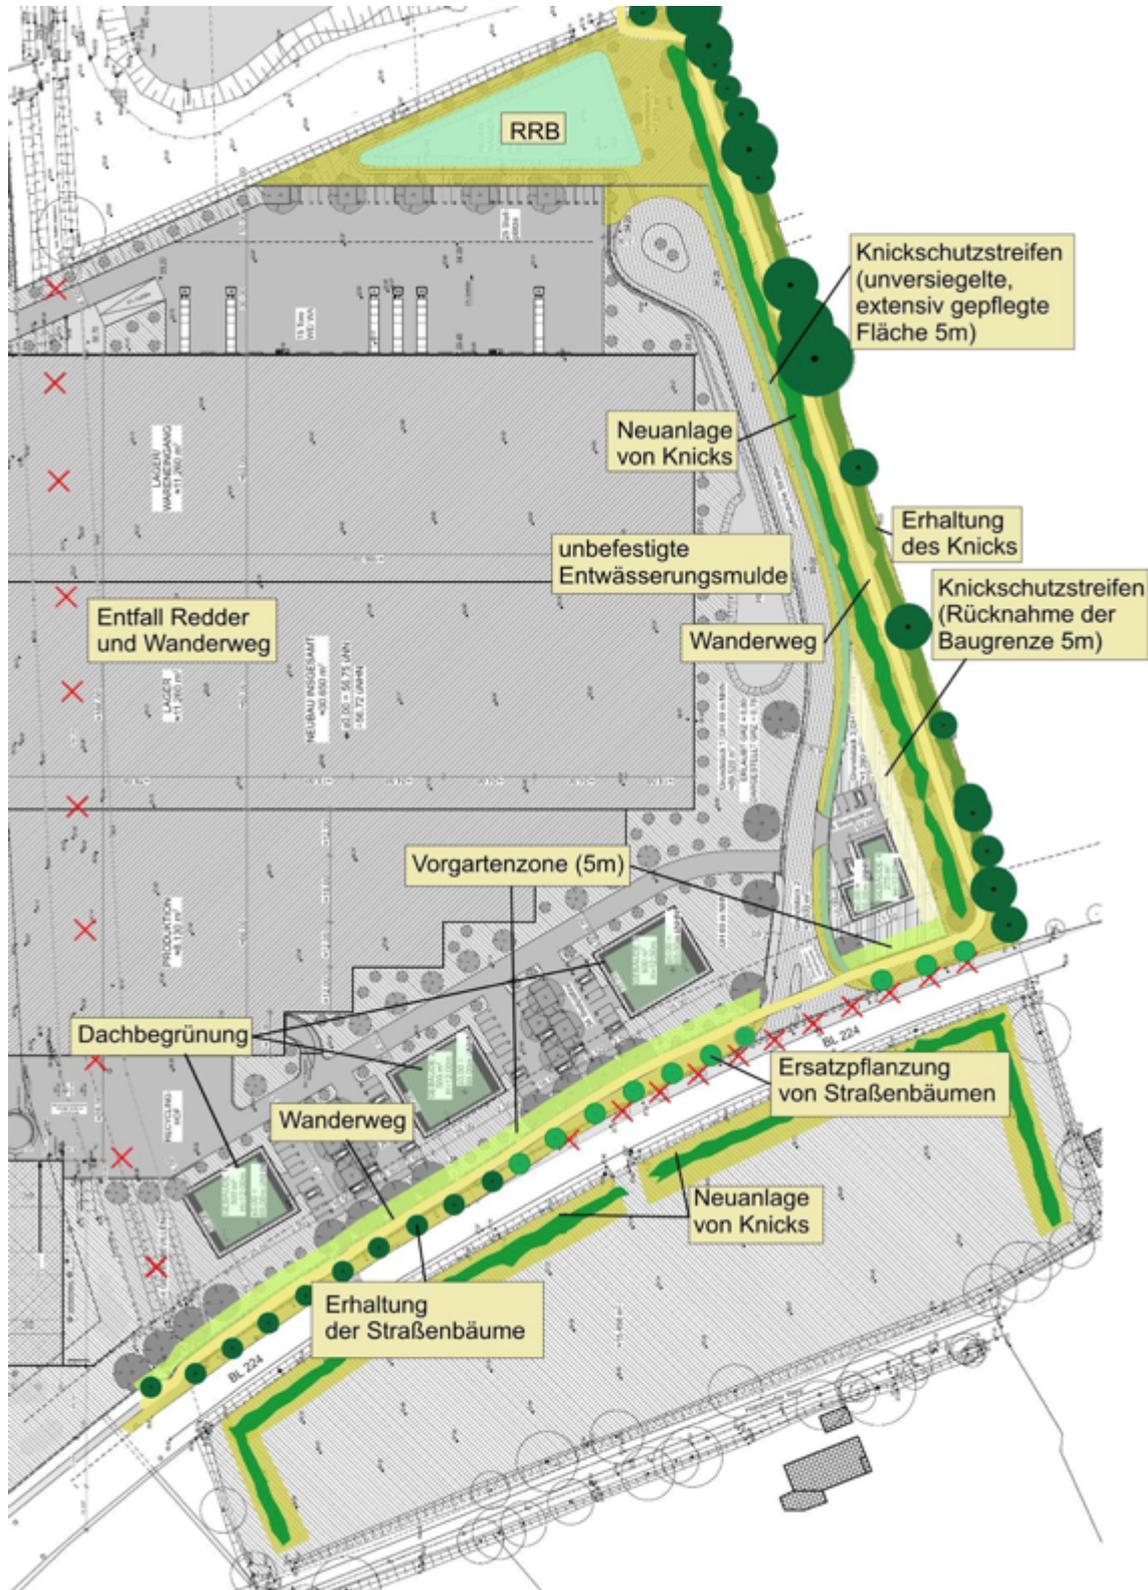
Skizze zum Entwurfsplan Grünordnerischer Fachbeitrag, o.M. (LPJ 2018, auf dem Konzeptentwurf INDUSTRIE PLANUNG 2018)
